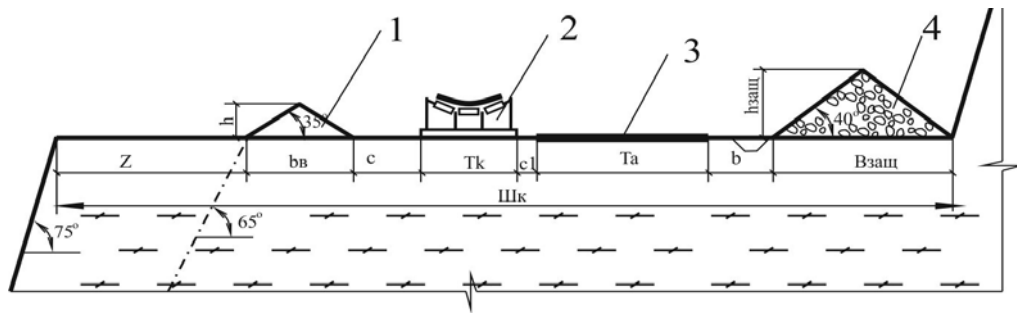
Схема расположения конвейерной установки в полутраншее: 1 – предохранительный вал; 2 – конвейерный став; 3 – техническая полоса; 4 – удерживающий вал
